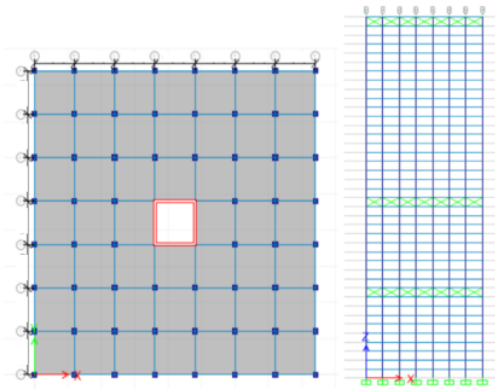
Vista en planta y elevación del modelo empleado en la investigación (Krunal et al., 2015, p.269)
